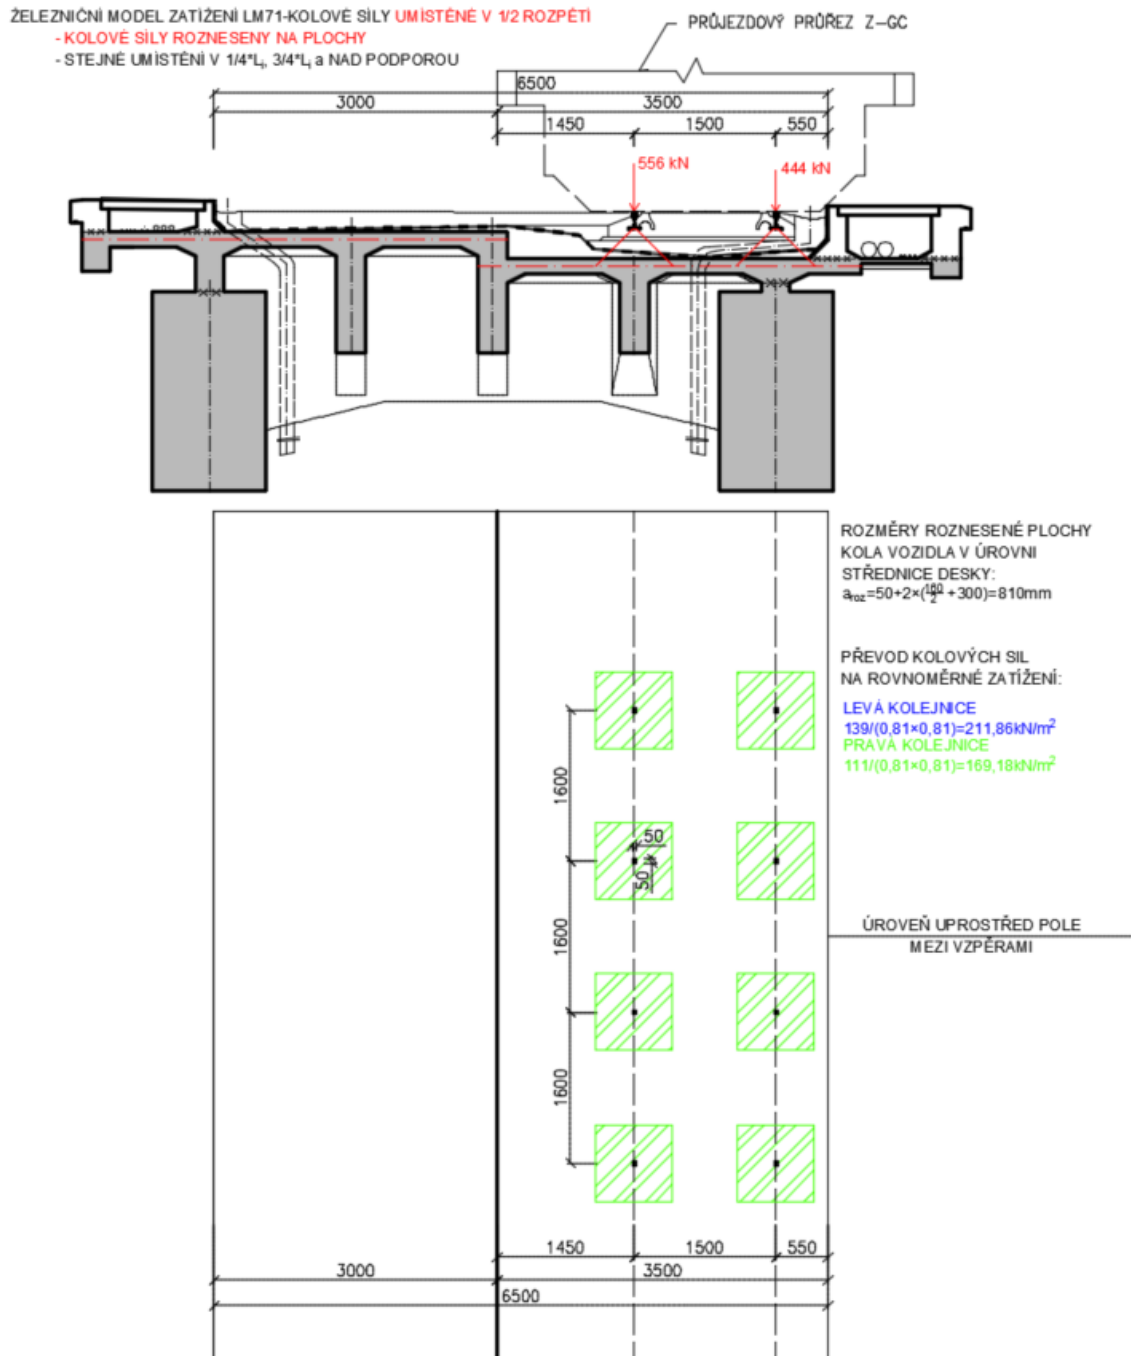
Schéma umístění kolových sil modelu LM71– varianta 1
